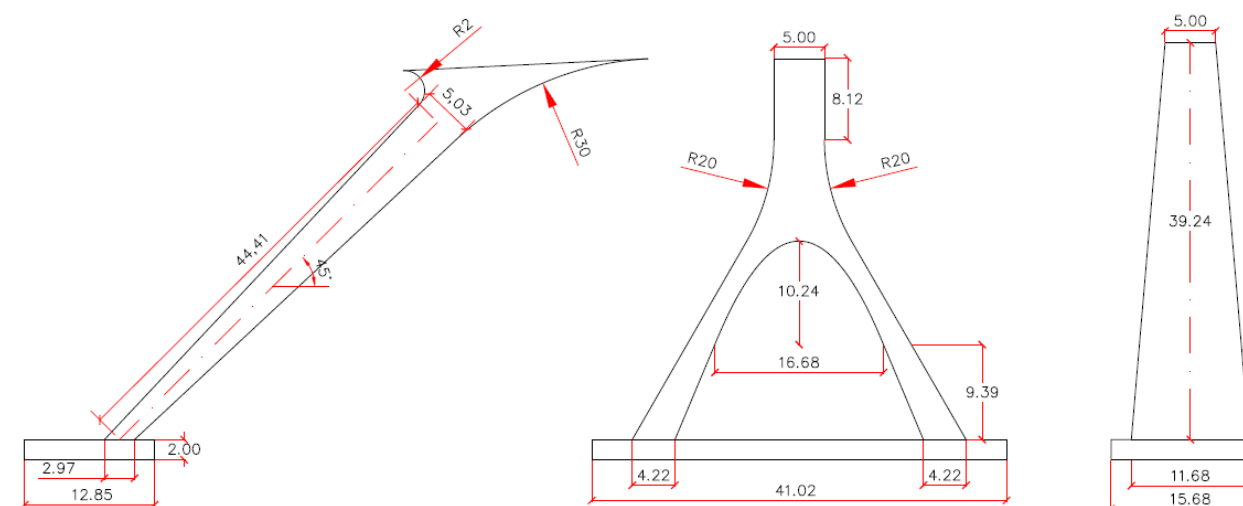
Planta (izq.) y alternativa 1 (centro) y 2 (dcha.) de perfil de pila 1 puente-pórtico
